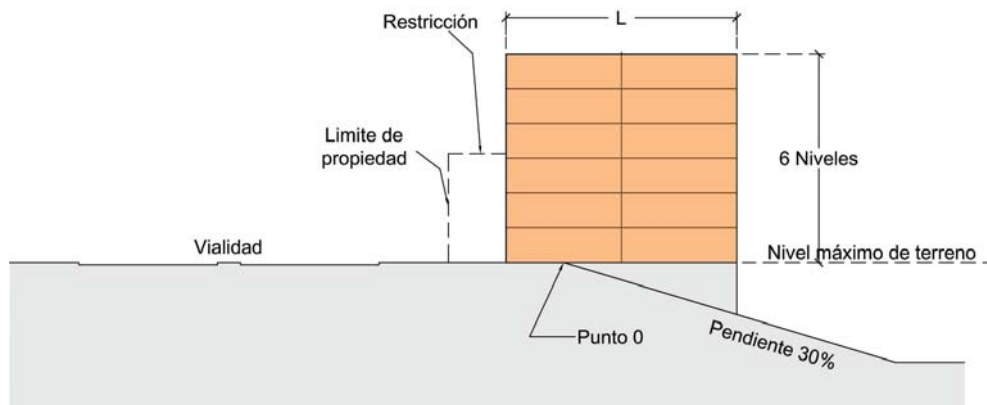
Desplante con terreno plano y pendiente descendente.
